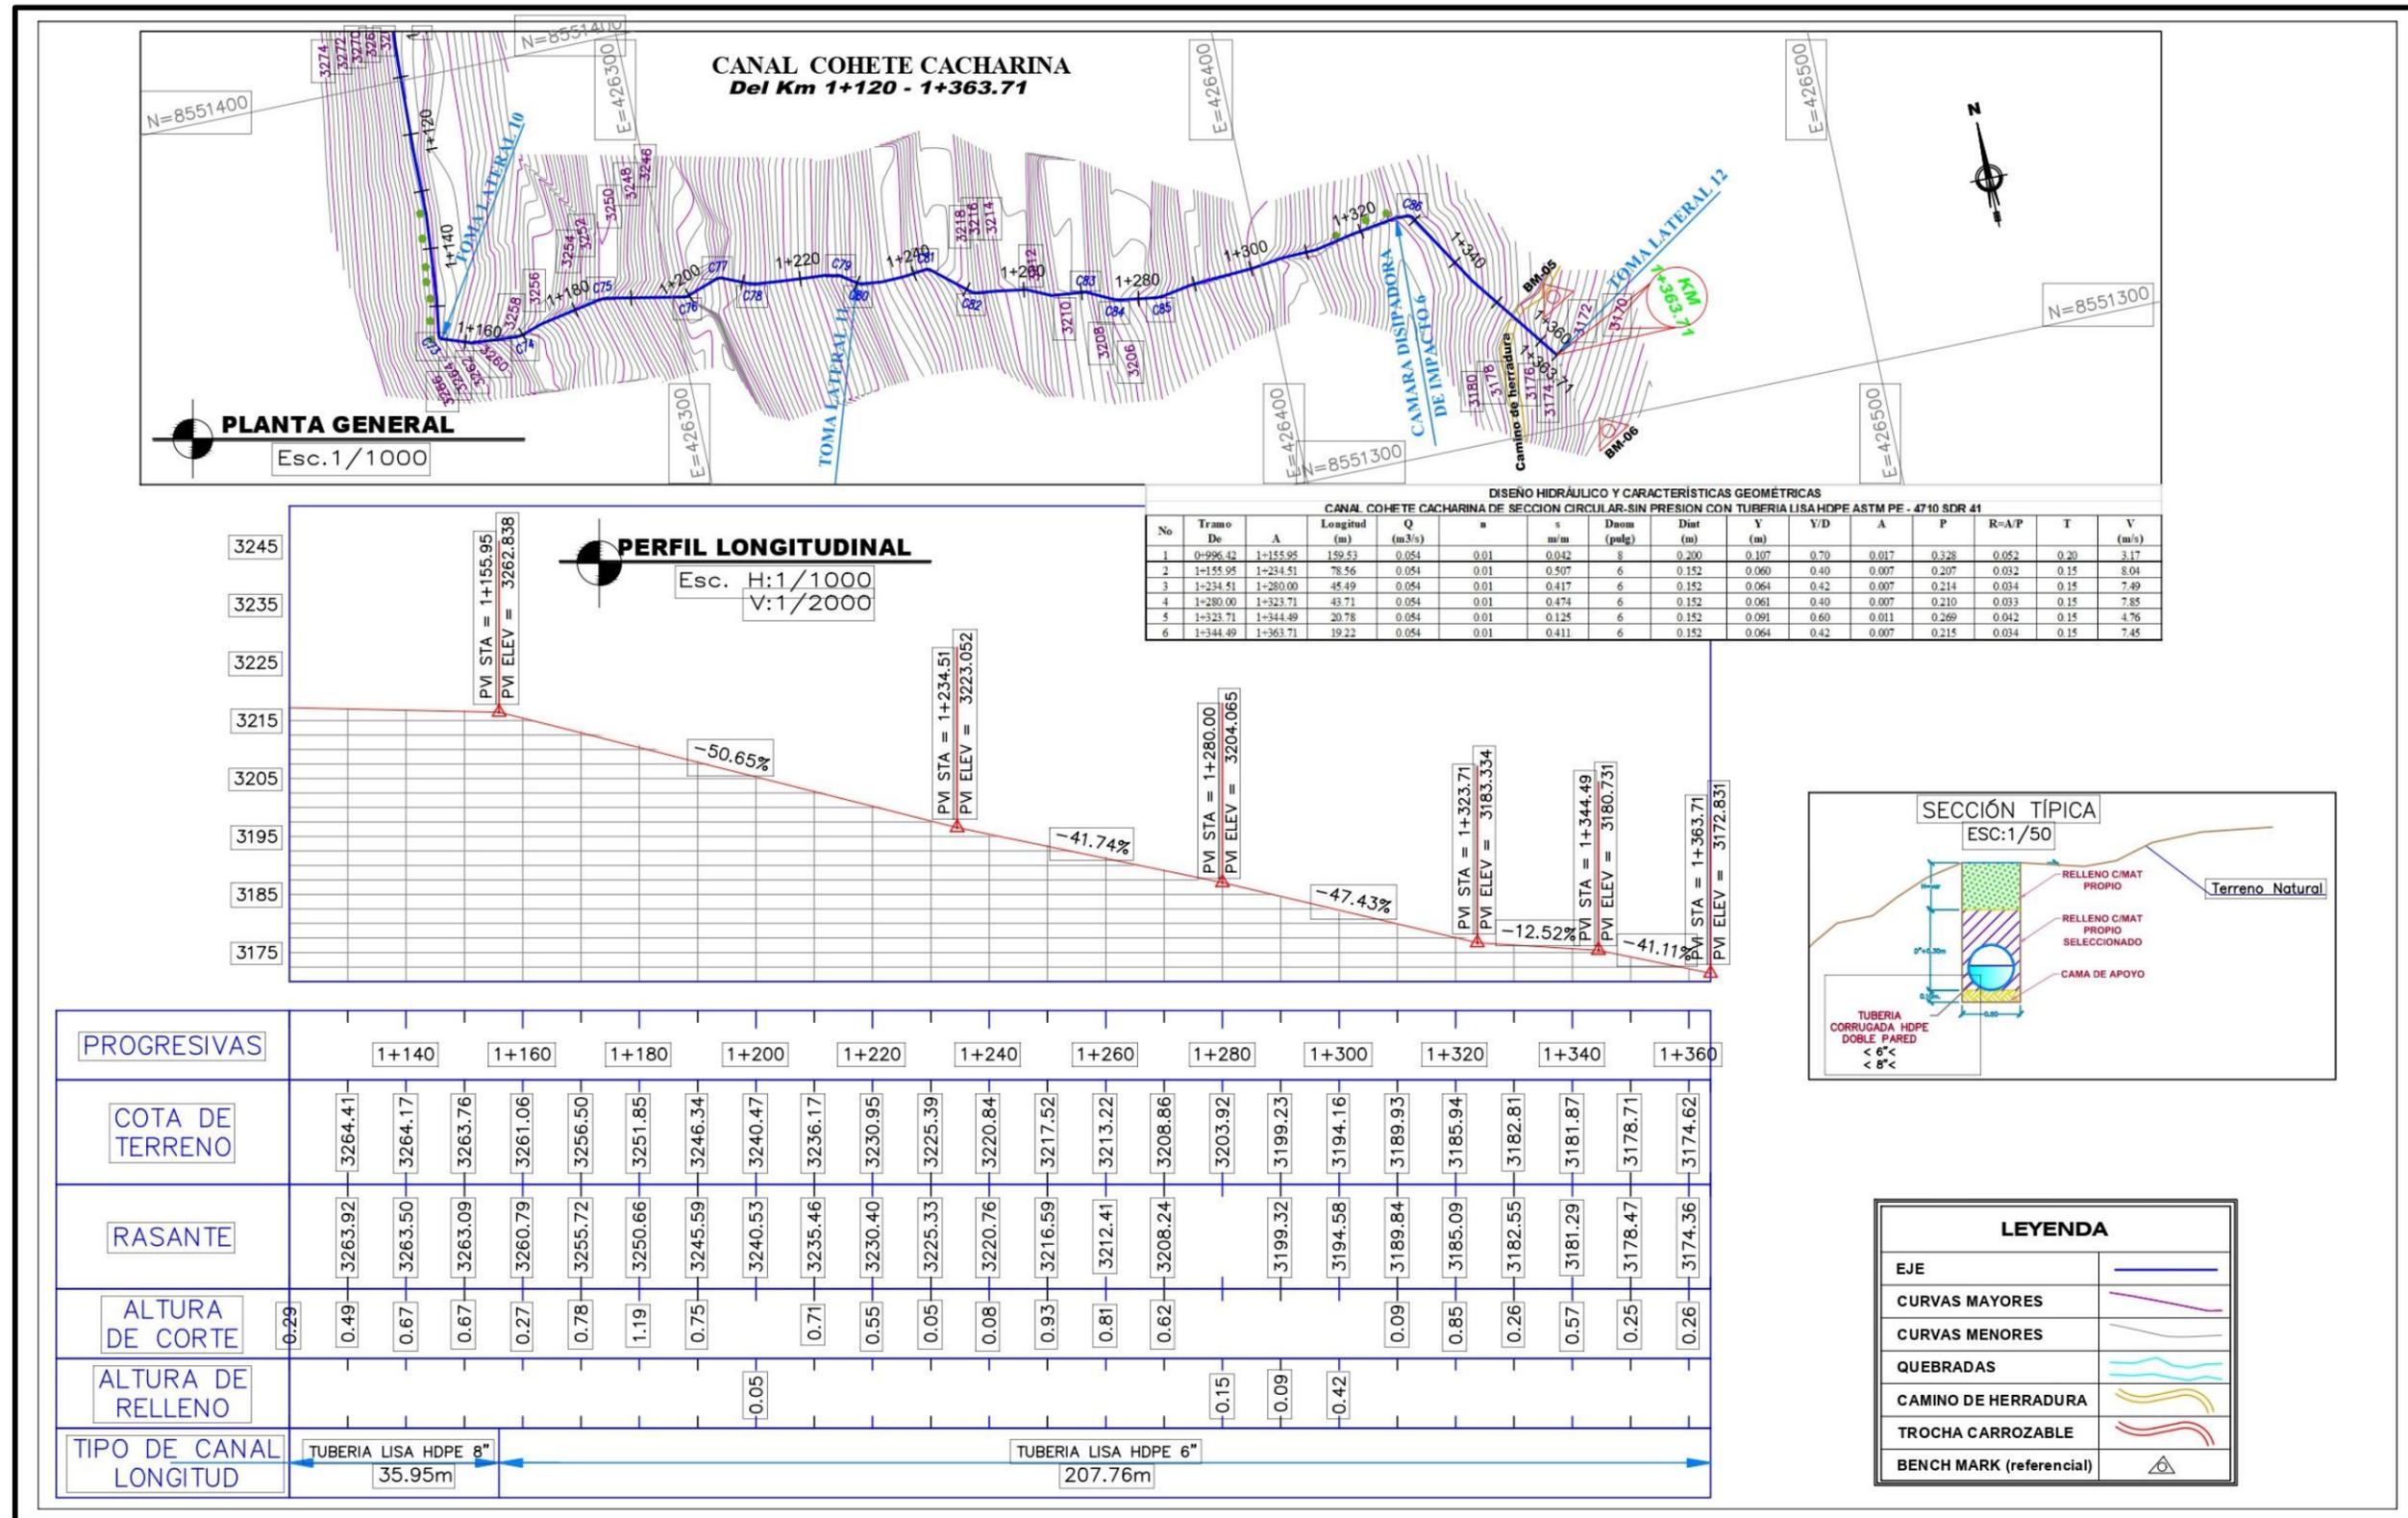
Plano de planta y perfil longitudinal del canal Cohete Cacharina
